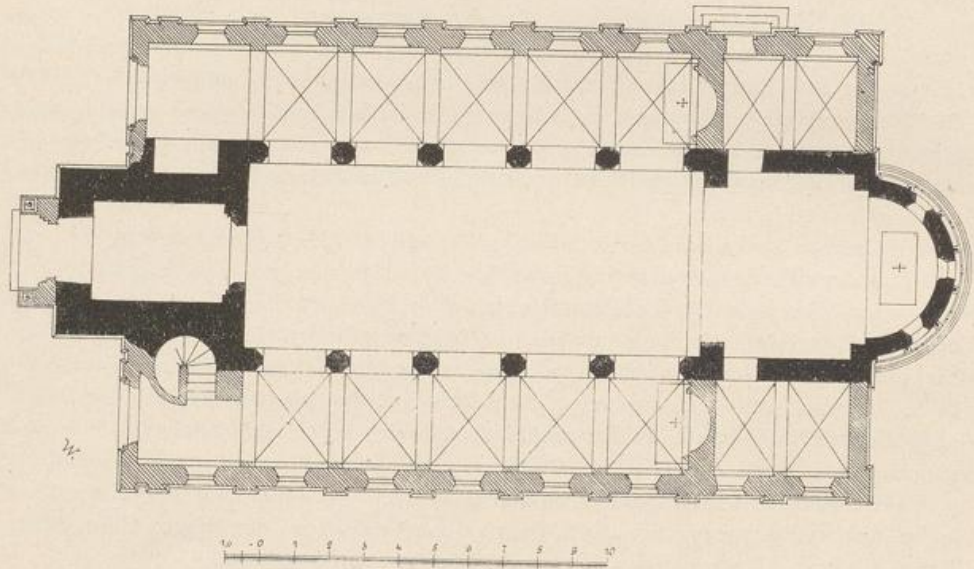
Oeckhoven. Grundriss der katholischen Pfarrkirche.
